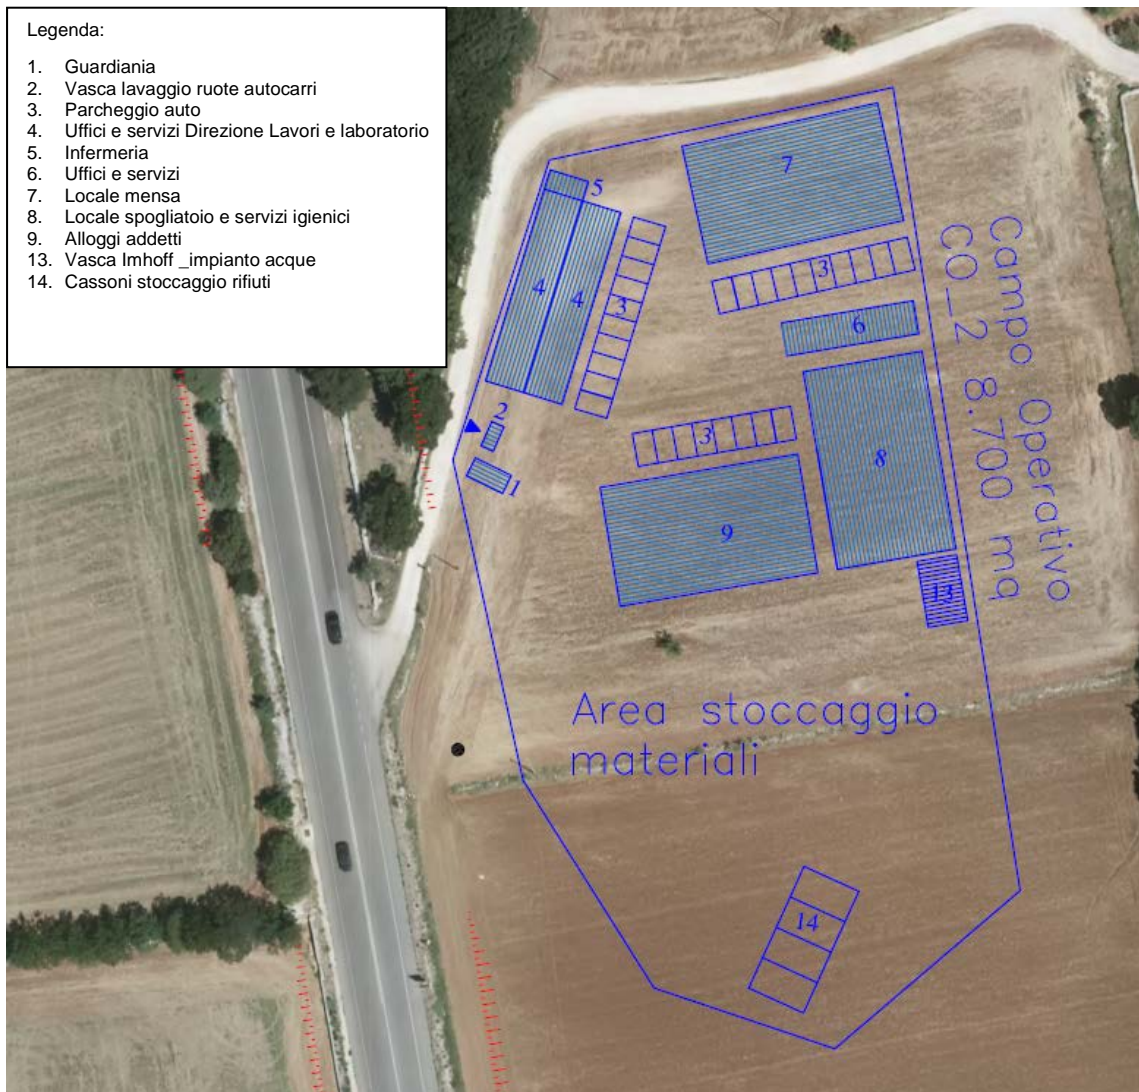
Ipotesi layout cantiere operativo CO_2
